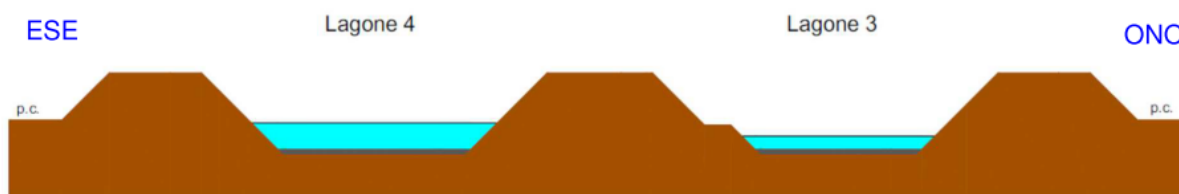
Sezione schematica Lagone 4 – Lagone 3
